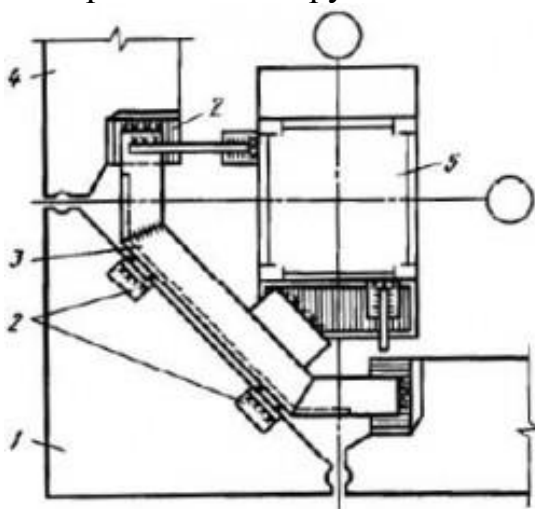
Крепление угловой стеновой панели к колонне:
